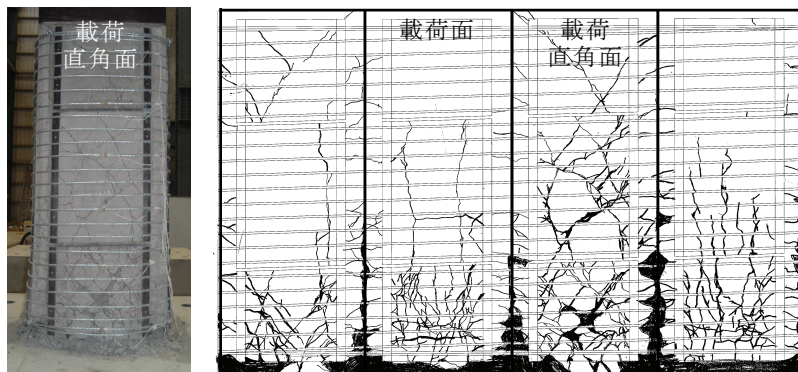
に、交番載荷試験終了後の各試験体についてセグメント撤去前後の損傷状況を示す。セグメント撤去前後において、載荷直角面の斜めのせん断ひび割れ、載荷面の水平の曲げひび割れはよく対応しており、柱隅角部やセグメント表面のひび割れ状況から、既設 RC 柱の損傷状況を目視で確認、推定することができることを確認した。
